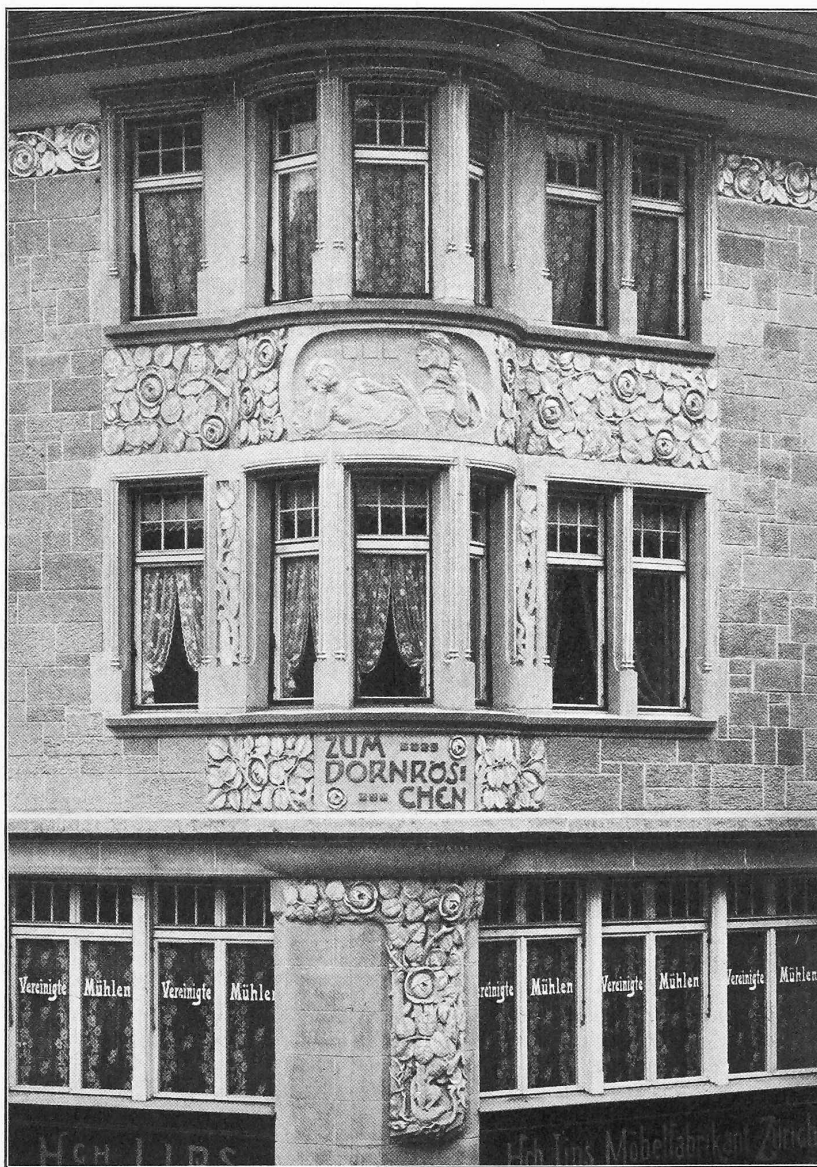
Detail vom Erker an der Ecke der Löwenstrasse und Gerbergasse.
